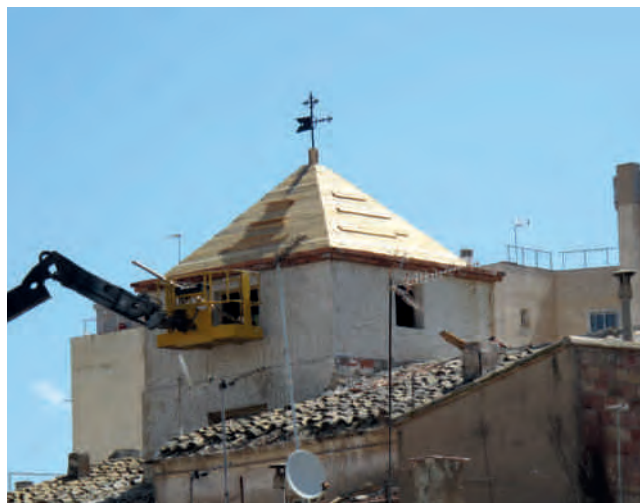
Colocación de la estructura de madera y tablero para recibir la teja.
